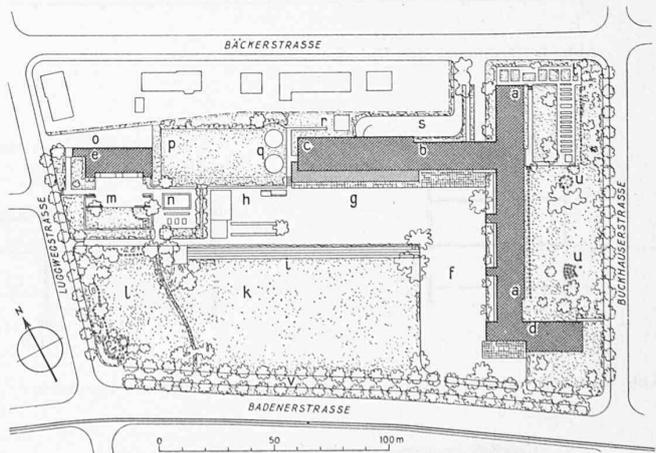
Lageplan der Schulhausanlage Zürich-Altstetten, 1 : 3000
